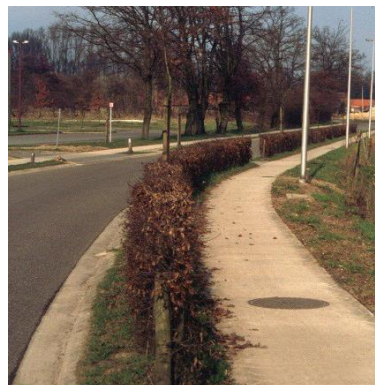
Vrijliggend fietspad afgeschermd door haag - Diepenbeek
